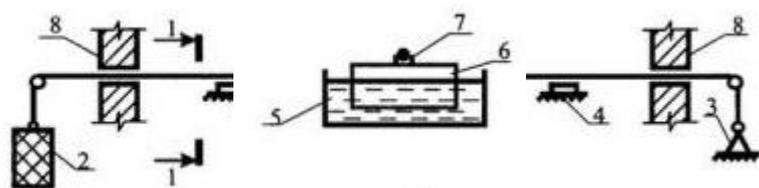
Конструктивная схема метода натянутой нити для определения горизонтальных смещений обследуемых строительных объектов: а - общая схема; б - схема плавающих опор; 1 - стальная проволока; 2 - натягивающий груз; 3 - неподвижная опора; 4 - плавающая опора; 5 - ванночки; 6 - поплавок; 7 - вилка фиксатора проволоки; 8 - ограждающие конструкции объекта
